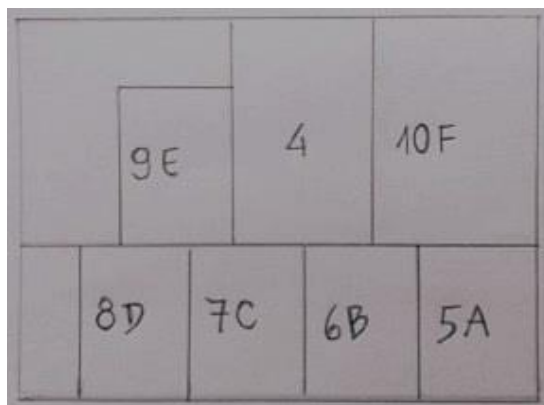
Planta que ilustra a arrumação das telhas sobre a estrutura de bambu. Foto de RAMILO, V. J. S, 2018.
